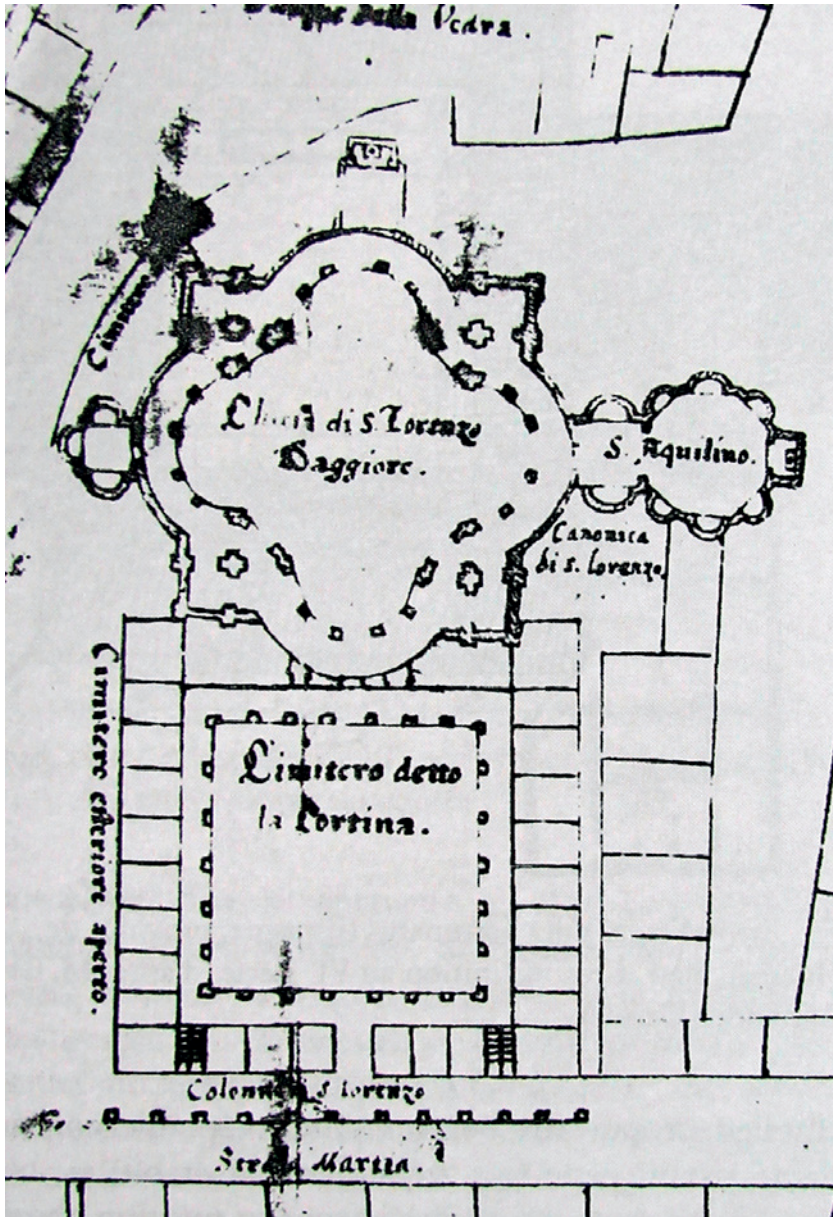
Complexe de Saint-Laurent de Milan, plan de 1608 (Milan, Archivio arcivescovile).
